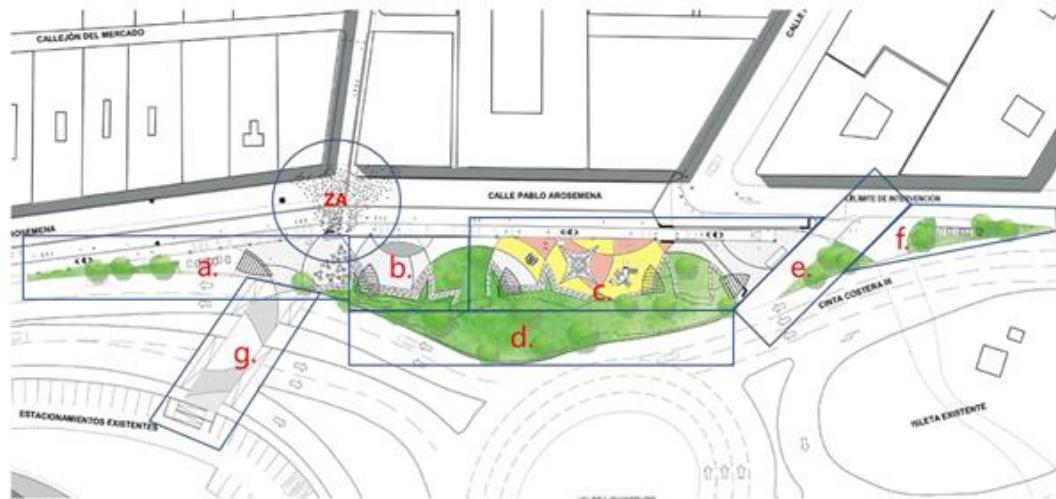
Zonificación de Proyecto - Planta general de intervención del proyecto
